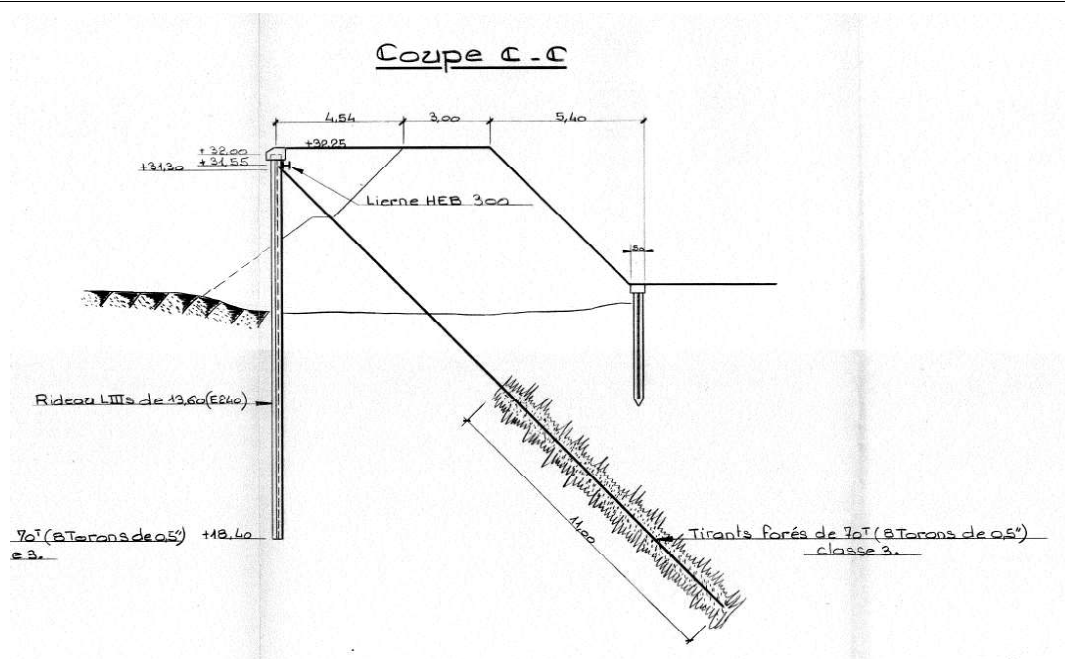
Coupe type associée au rideau tirant - zone barrage (Archives VNF)
